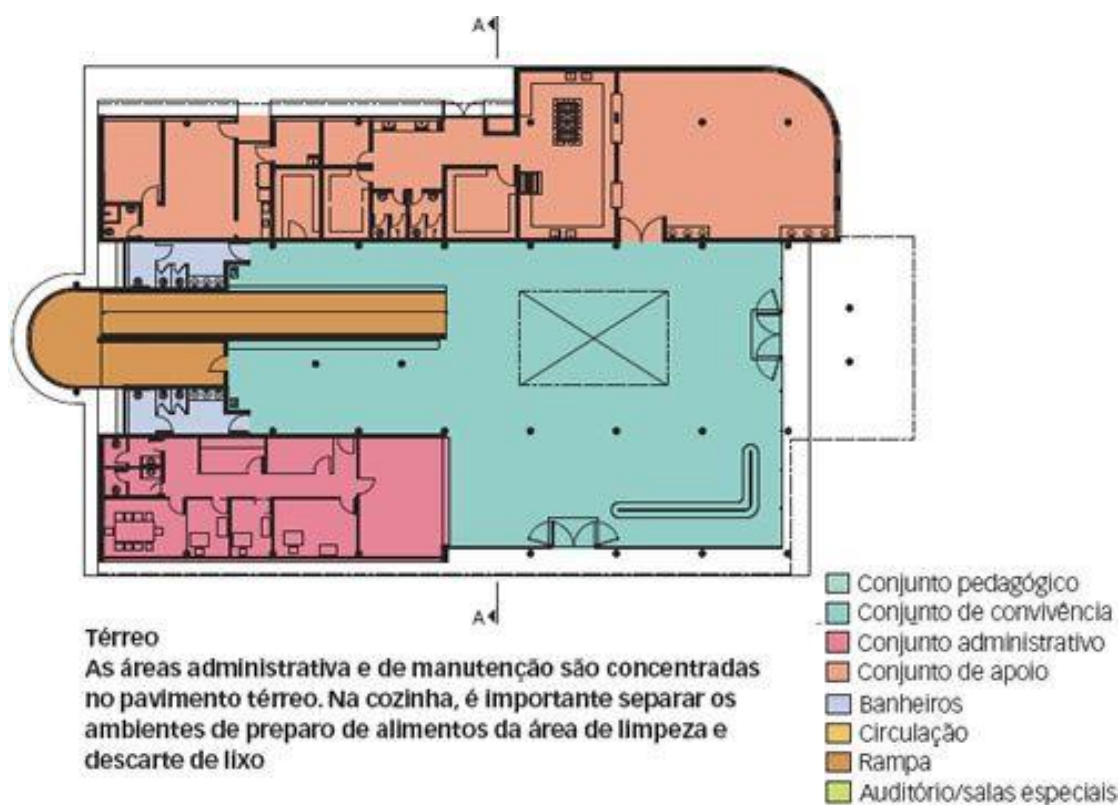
Planta do Pavimento Térreo. Fonte: Infraestrutura, 2011
